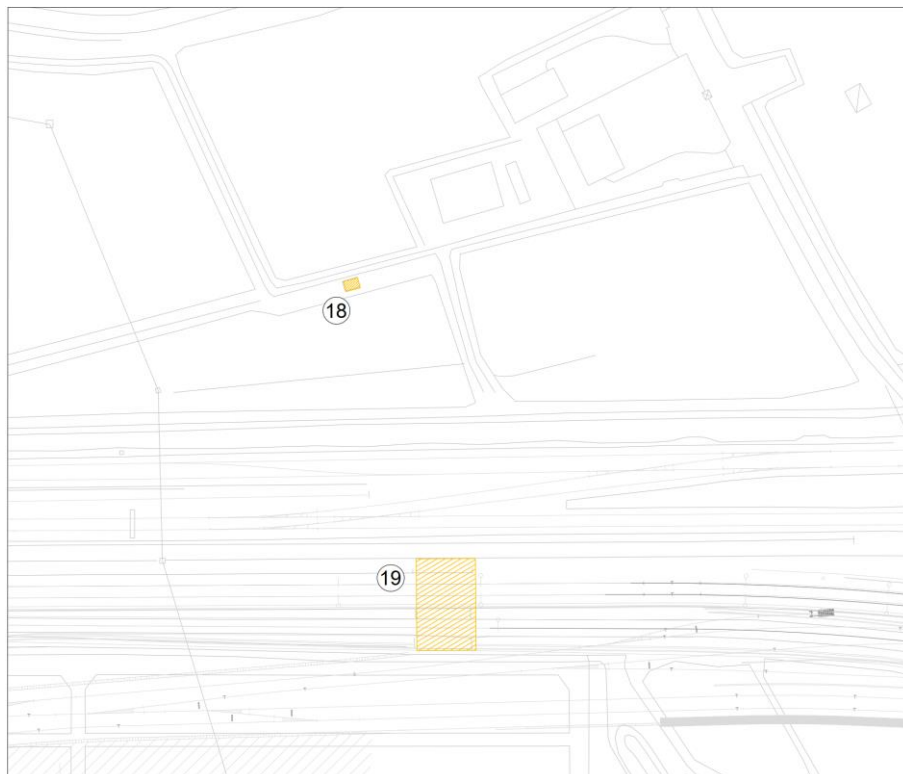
Stralcio planimetrico zona nuovo Sottopasso di Via Carnia
